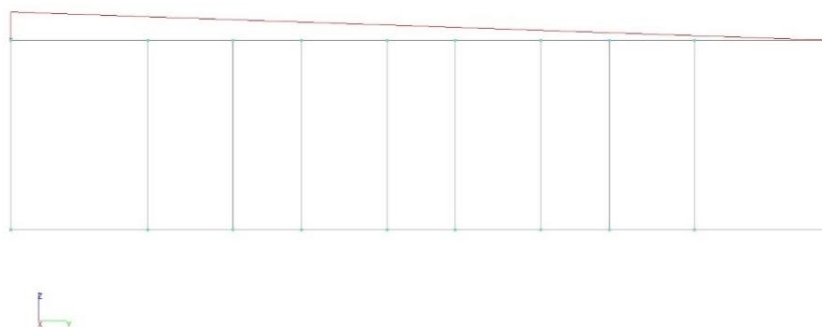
Фрагмент расчетной модели элемента стены: а) расчетные схемы 1, 3; б) расчетные схемы 2, 4 (вид сбоку)
